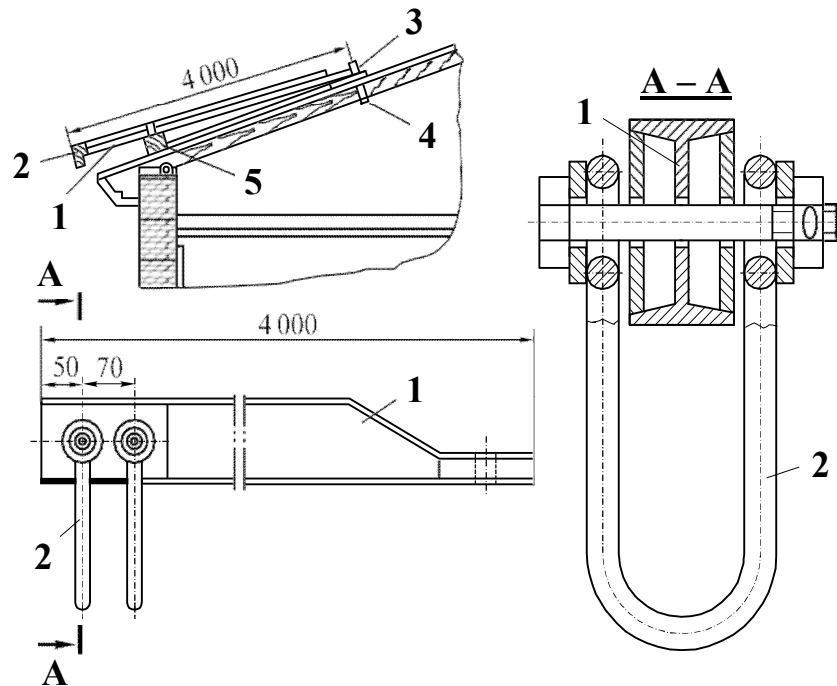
Інвентарна консоль для підвішування кошиків на фасадах будівель зі скатними дахами:
